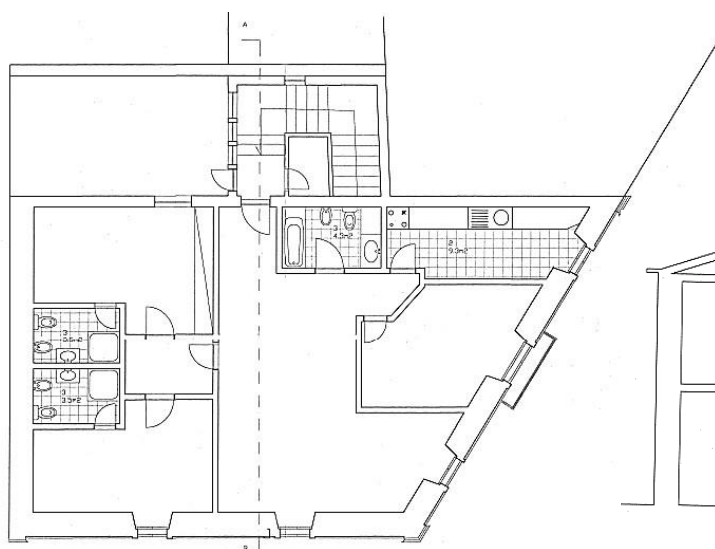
Planta do Piso 1 da proposta - Esc.1/200
